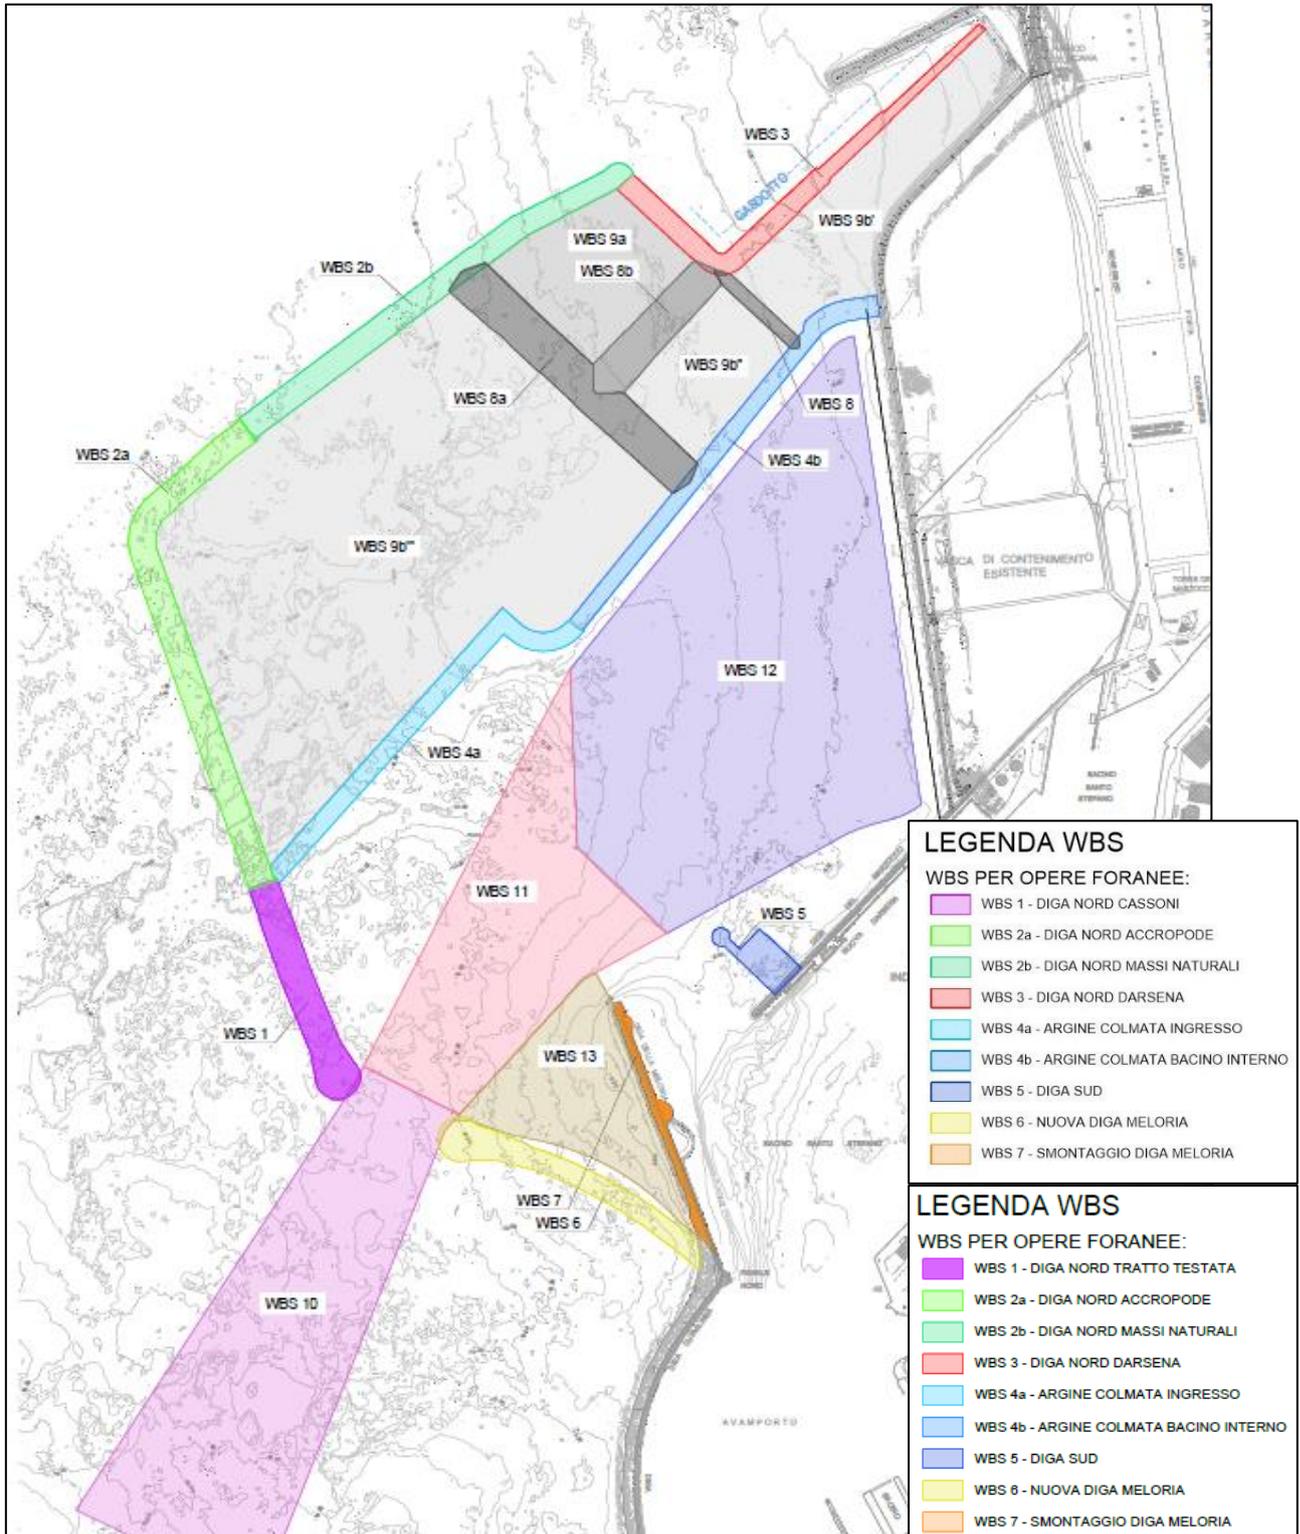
Planimetria di progetto con rappresentazione dei corpi d'opera
